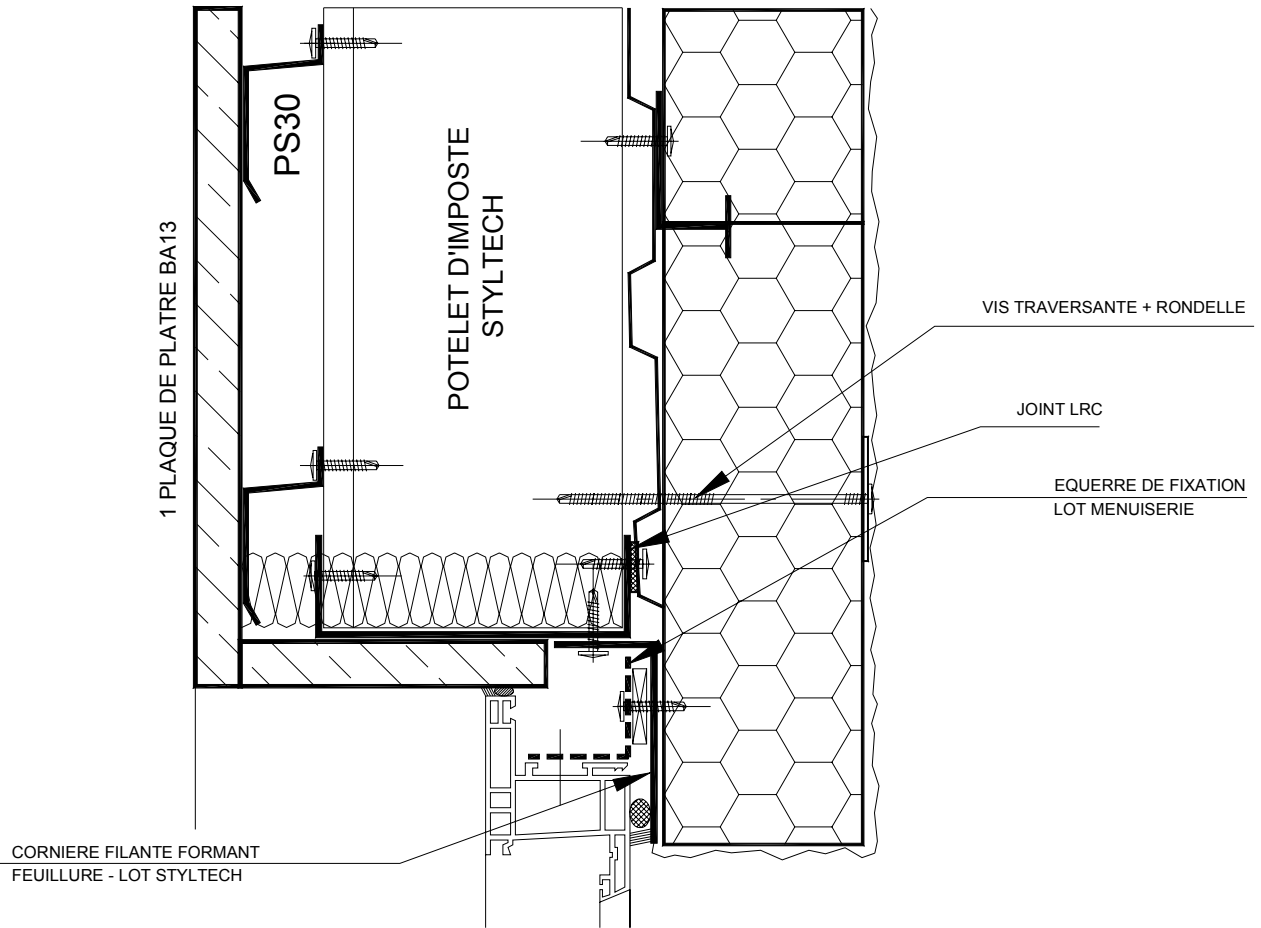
Coupe verticale sur fenêtre – Traverse haute – Menuiserie demi-mur
